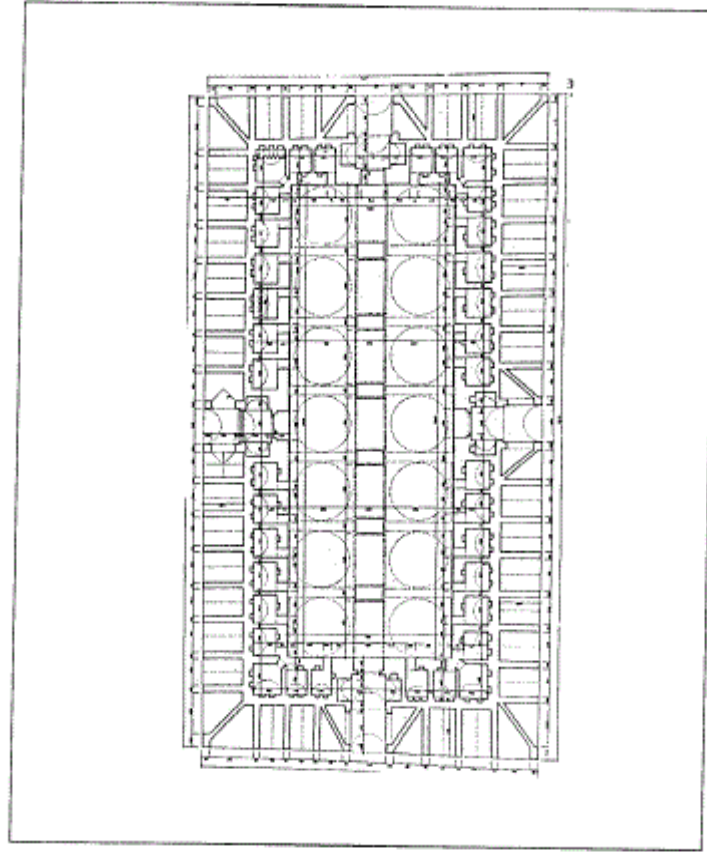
مسقط أفقي لحمام غازي اورنوس بك في سالونيك باليونان (عن : كيل) .
